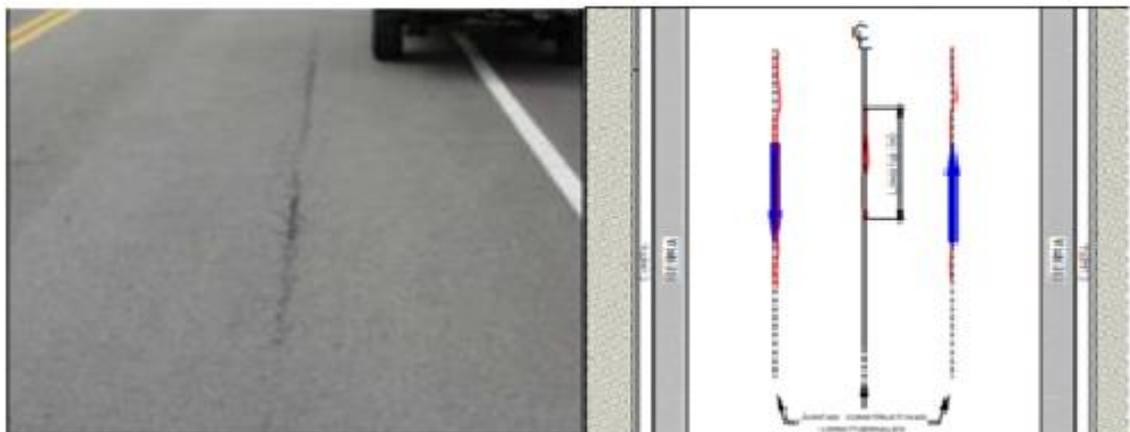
Fisuras en juntas de construcción [19].
